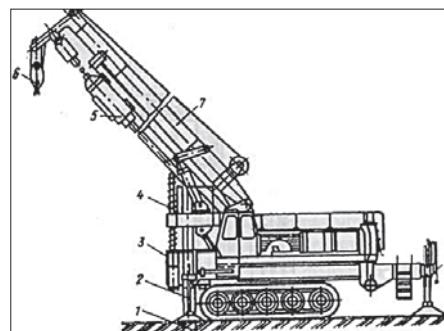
Схема вдавливающей установки УСВ-120М: 1 — свая; 2 — аутригер боковой; 3 — механизм зажима и вдавливания свай; 4 — шнек; 5 — вращатель шнека; 6 — крюк-блок; 7 — стрела; 8 — аутригер задний
